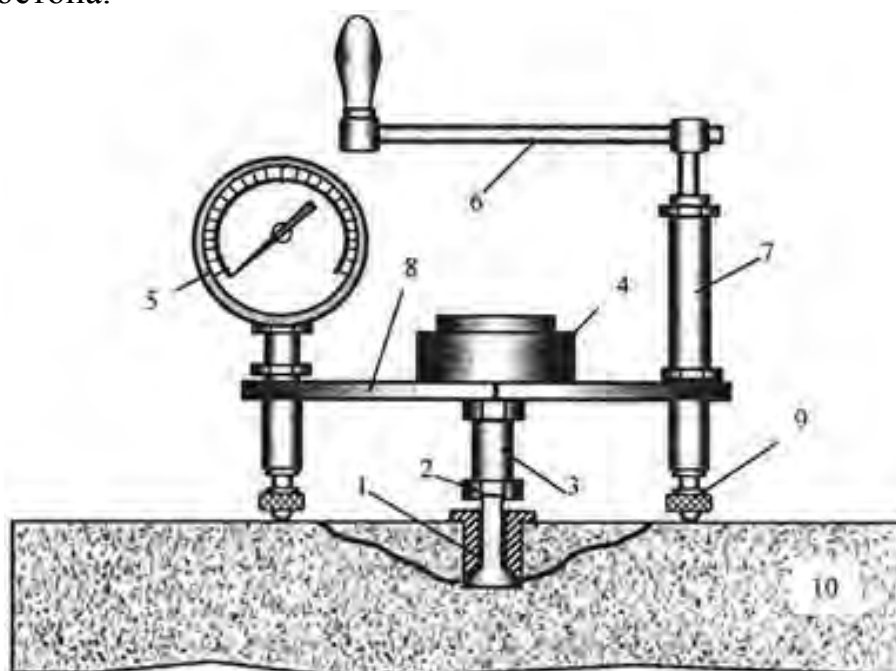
Принципиальная схема испытания. 1 – анкерное устройство; 2 – захват; 3 – шток рабочего цилиндра; 4 – рабочий цилиндр; 5 – манометр; 6 – ручка; 7 – винтовой насос; 8 – раста прибора с маслопроводом; 9 – ножки со сферическими опорами; 10 – исследуемый бетон
